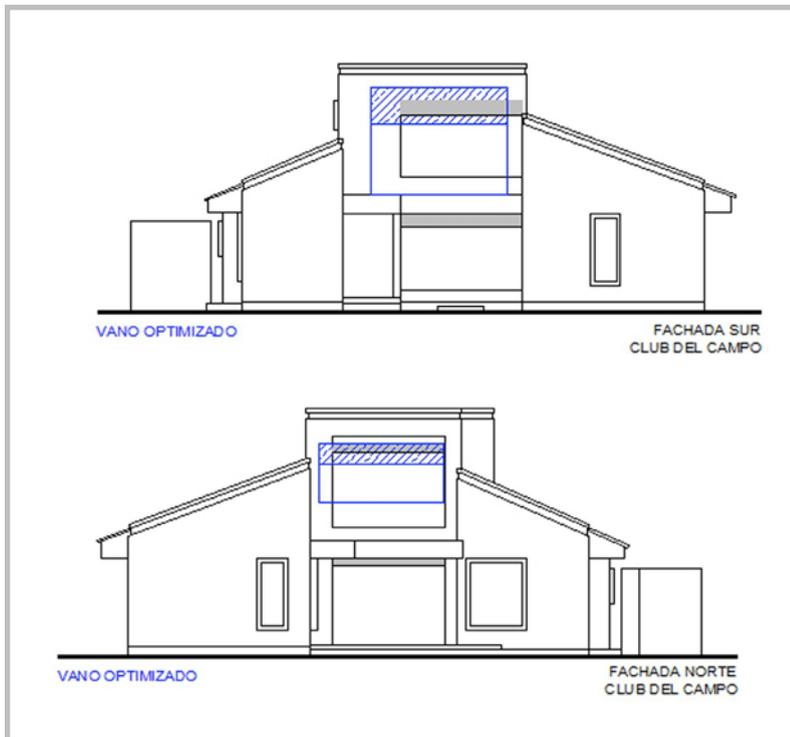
Vano original y optimizado para fachadas Norte y Sur vivienda “Club del campo”. El vano original tiene una relación vano planta de 47% con apertura de 11% la nueva propuesta tiene una relación vano planta de 41% con apertura de 33%.
